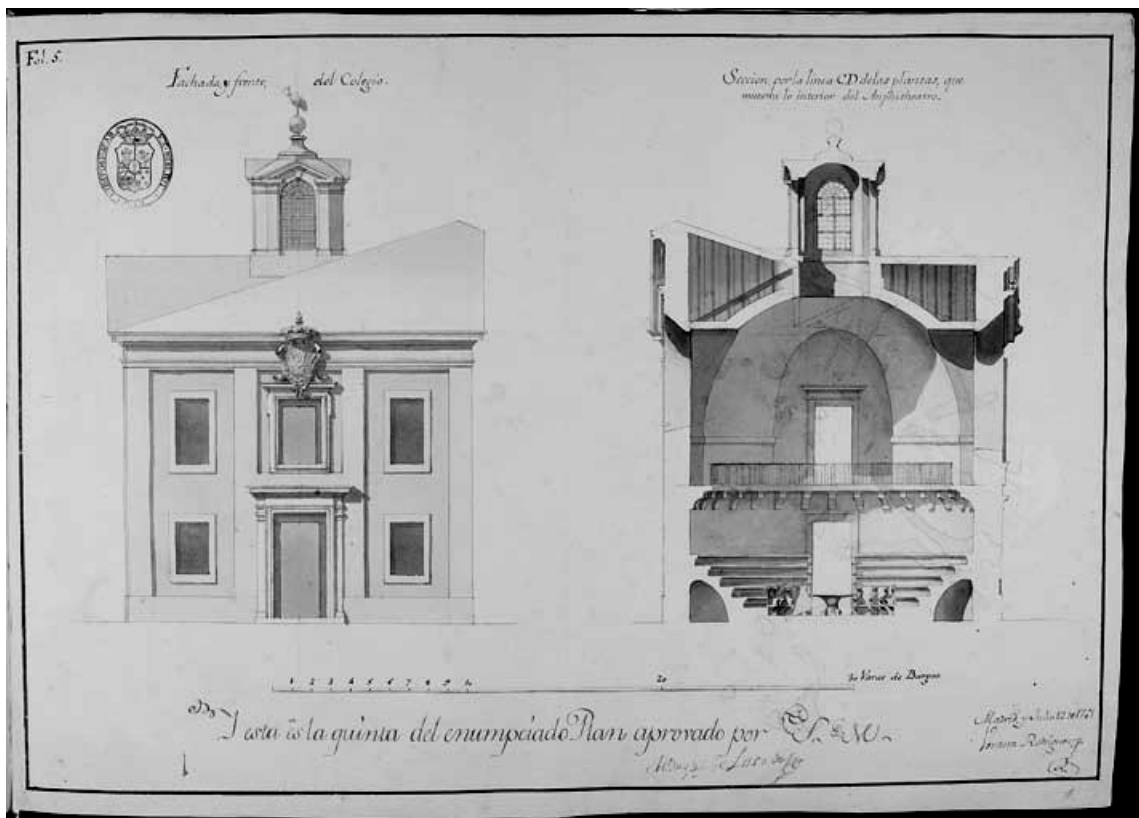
Real Colegio de Cirugía de Barcelona, elevación fachada sureste y sección transversal por anfiteatro anatómico en el sentido NE-SO. © Archivo USC.
